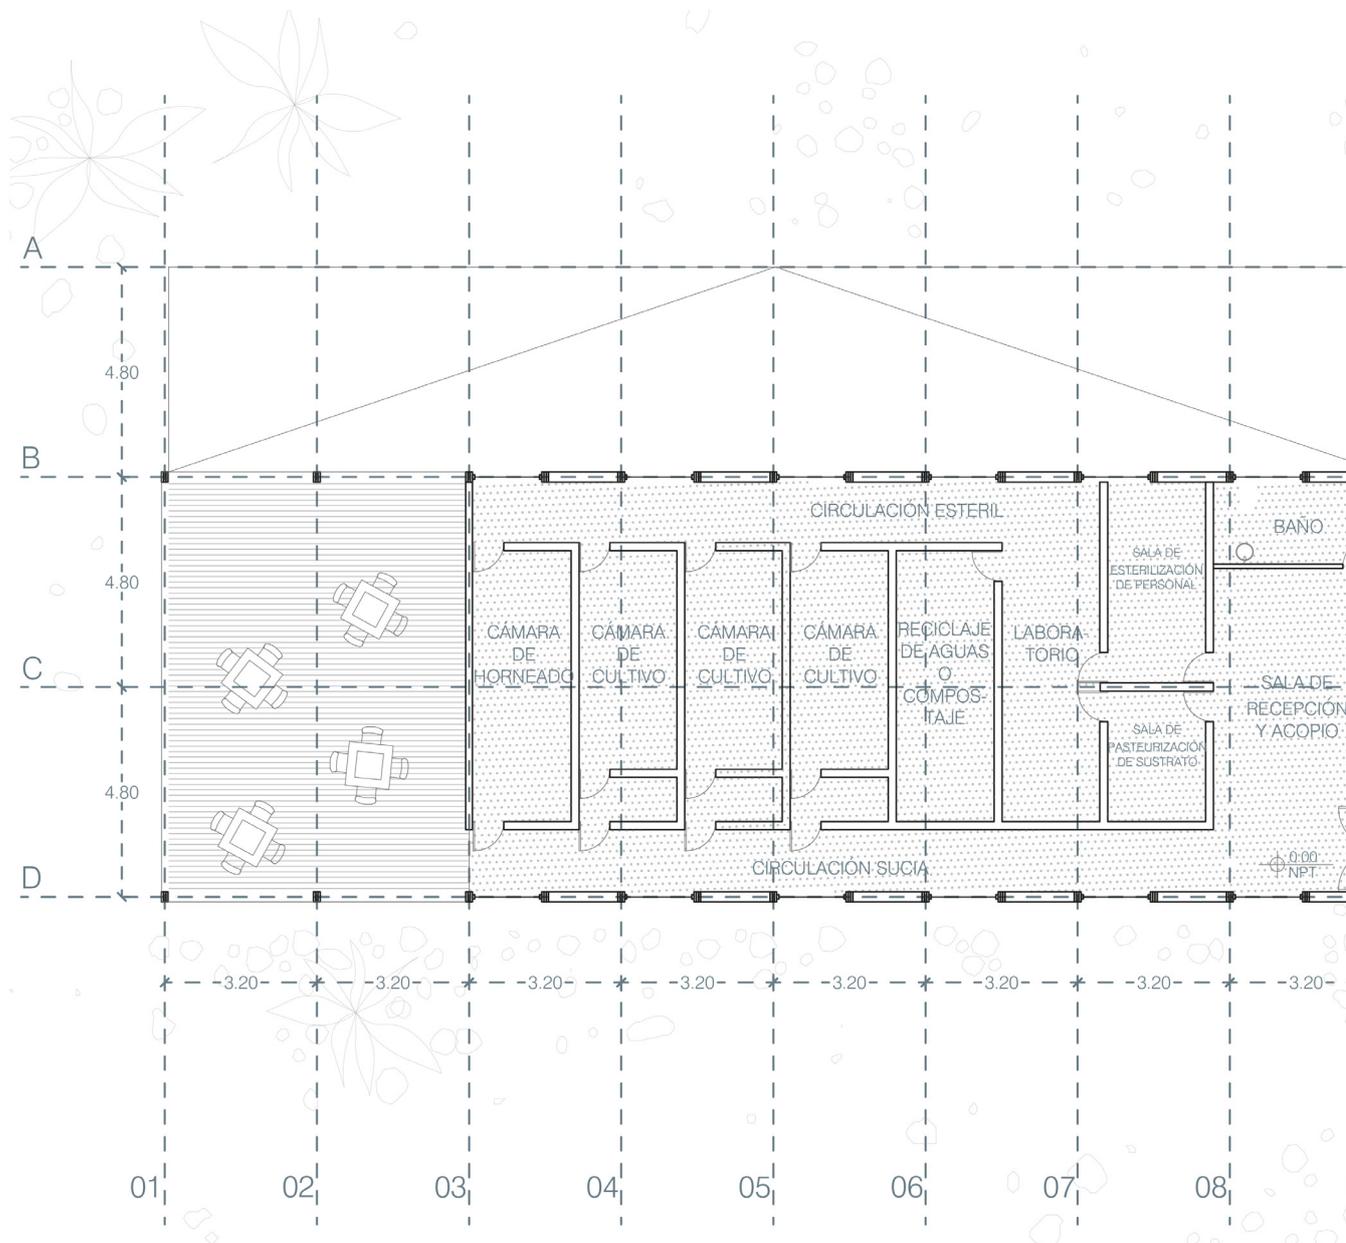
Planta Nivel 2 Edificio Río. Elaboración propia.
